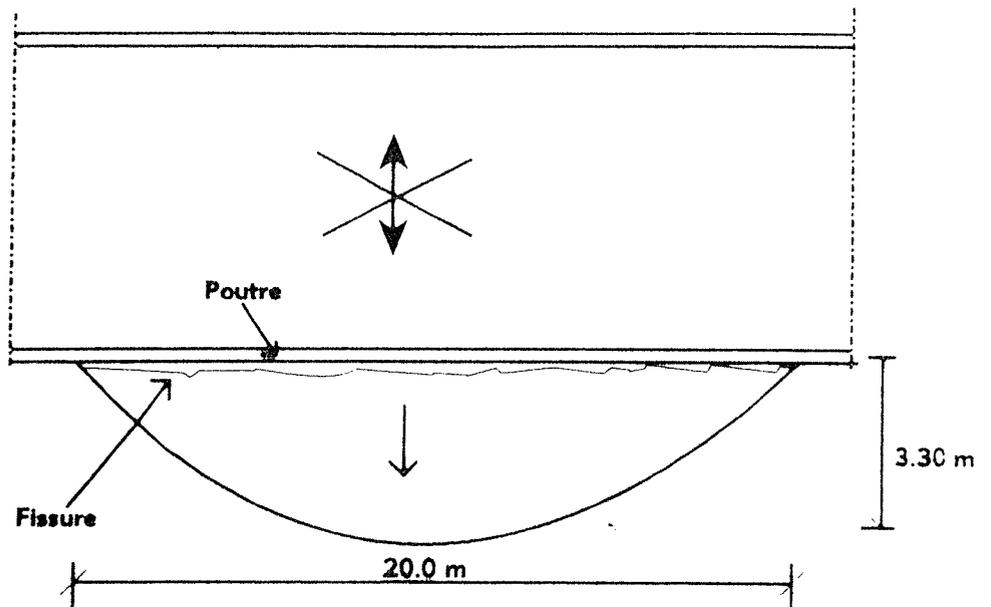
Dimensions de la dalle et position de la fissuration.
